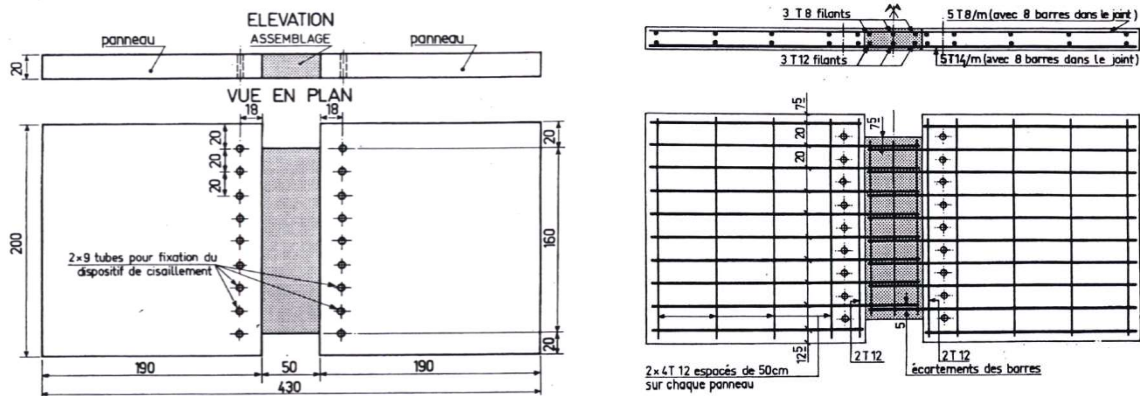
Géométrie des corps d'épreuve testés par (Kavrychine et Soubret, 1976) – dimensions en cm
